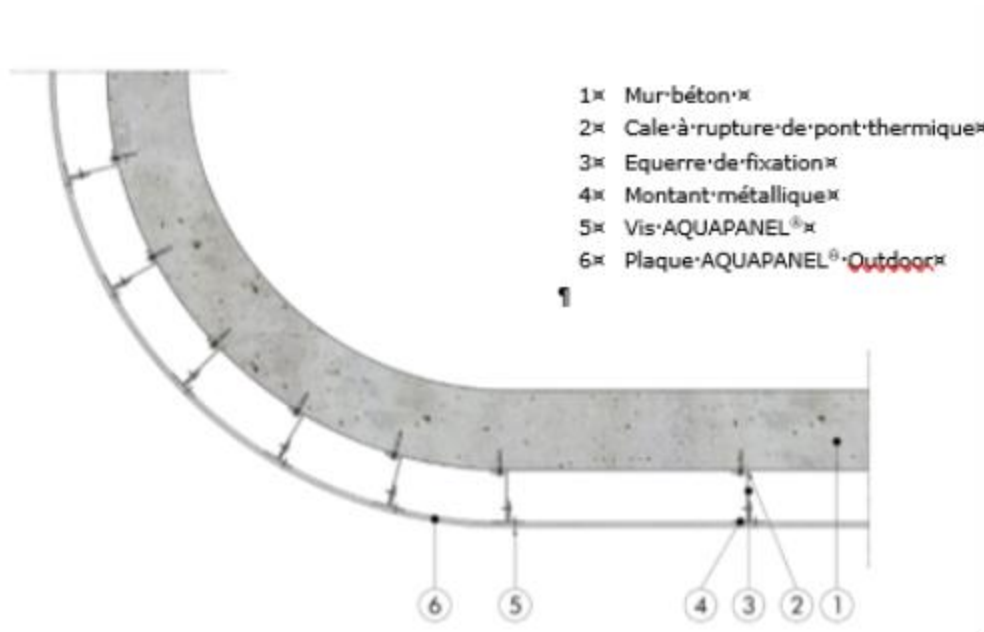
Mise en œuvre des plaques cintrées – coupe horizontale
